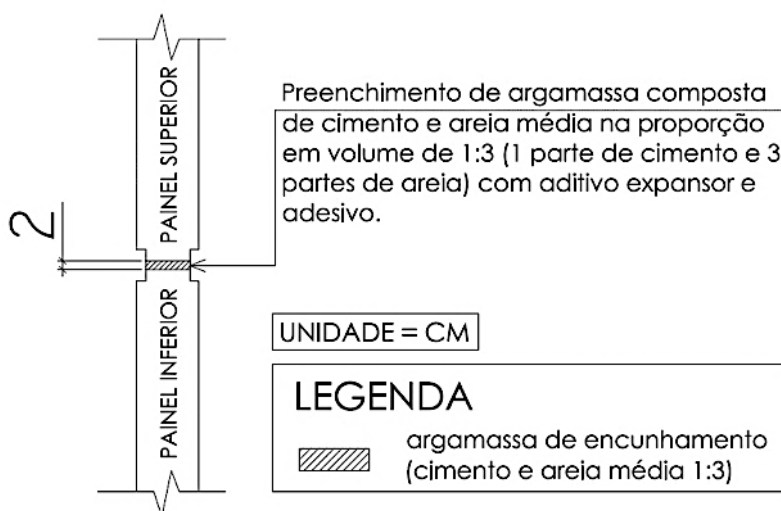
Aplicação da argamassa de encunhamento entre painéis sobrepostos.
